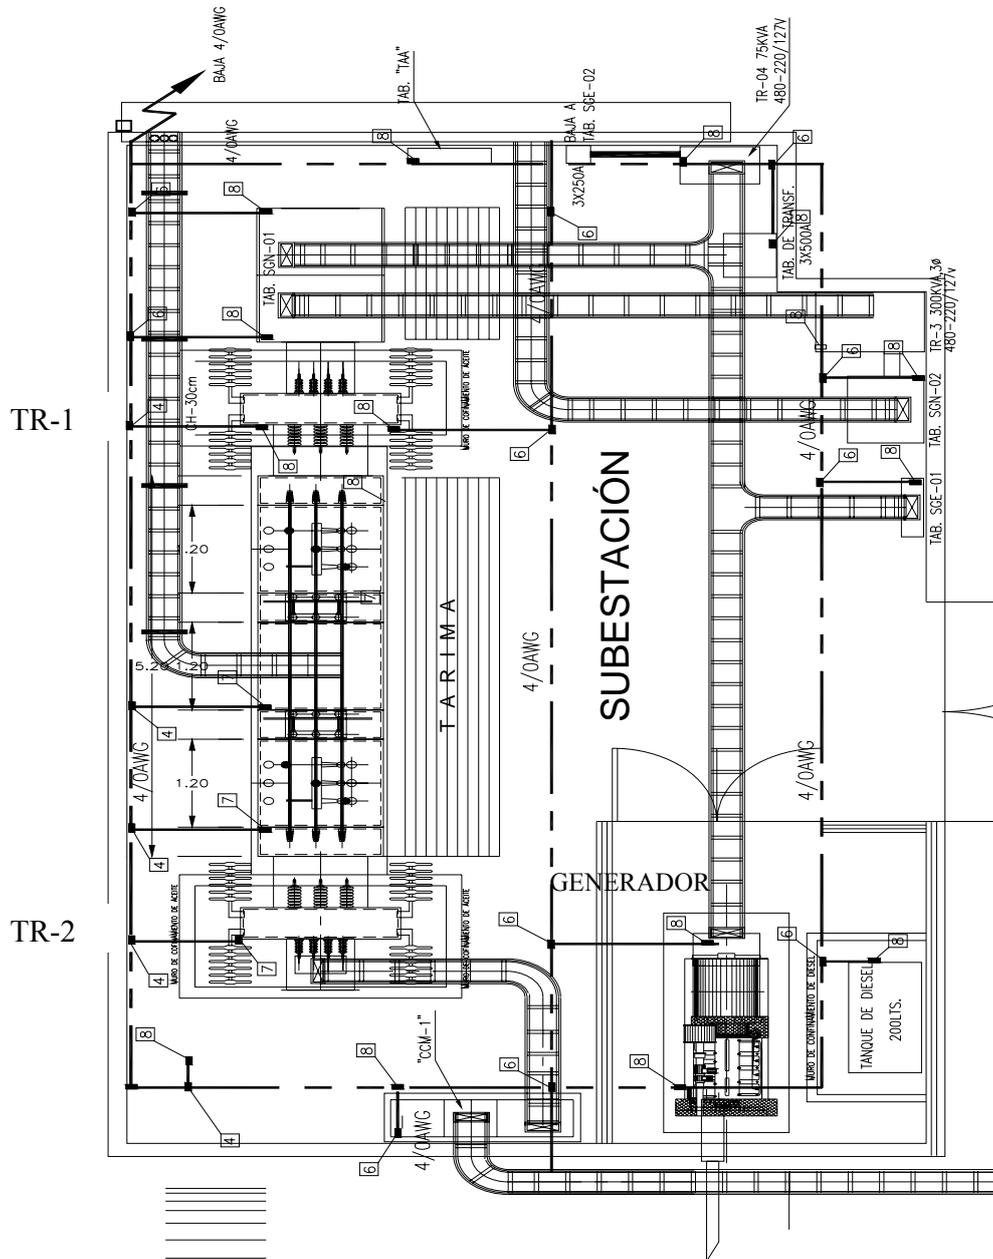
SUBESTACION ELECTRICA, PLANTA DE EMERGENCIA Y SISTEMA DE TIERRAS DE LA SUBESTACION.
